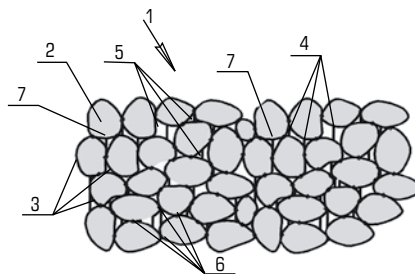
Фрагмент общего вида конструкции оснований и/или покрытий транспортного сооружения:
